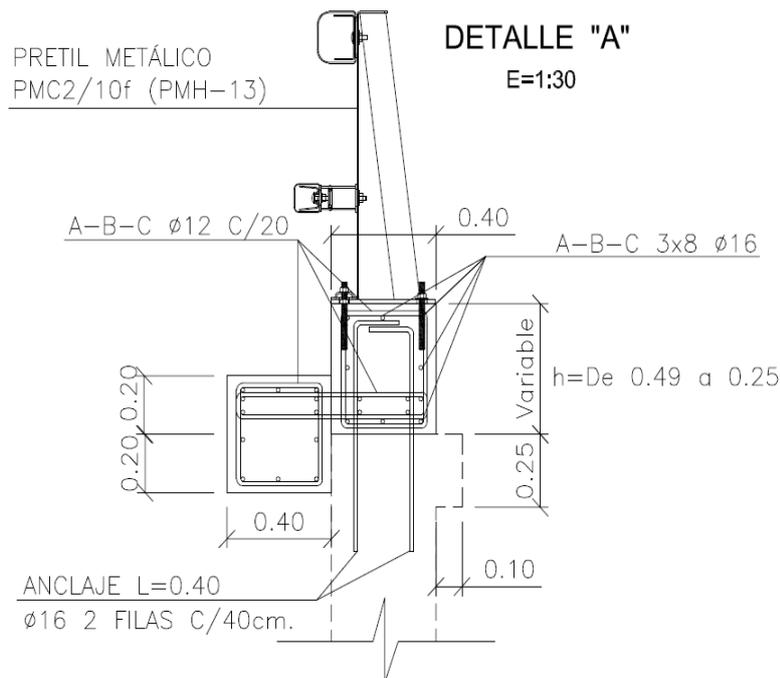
Detalle de cimentación, armado y dimensiones del pretil metálico PHM-13 colocado sobre la estructura de hormigón.
